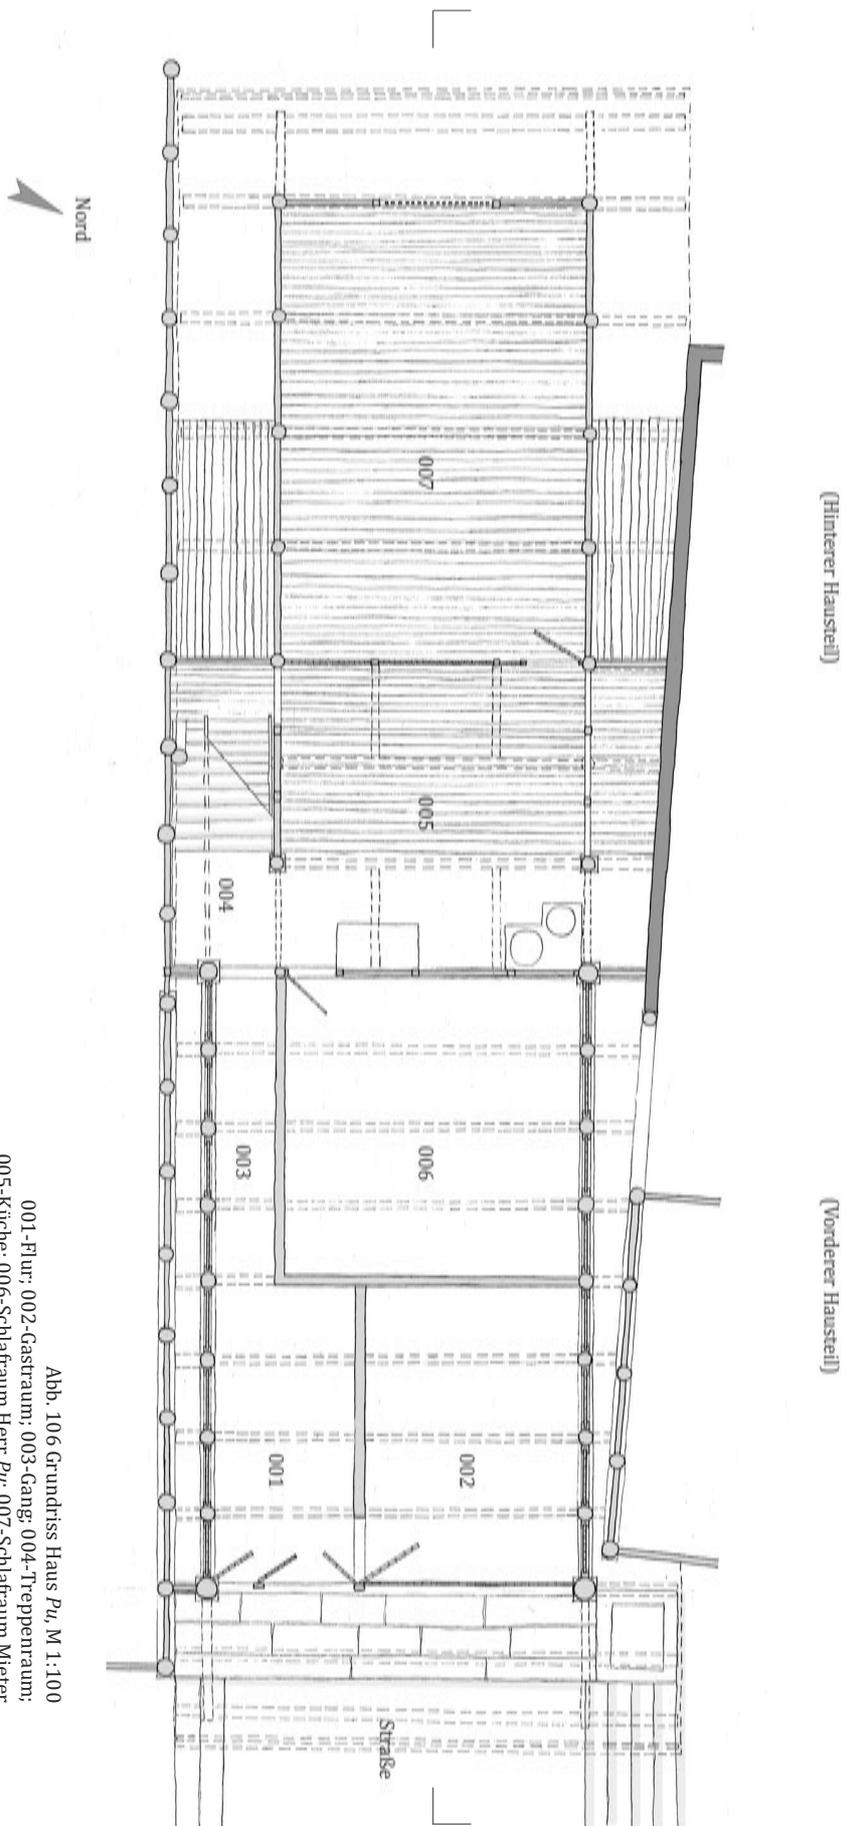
Grundriss Haus *P_u*, M 1:100
